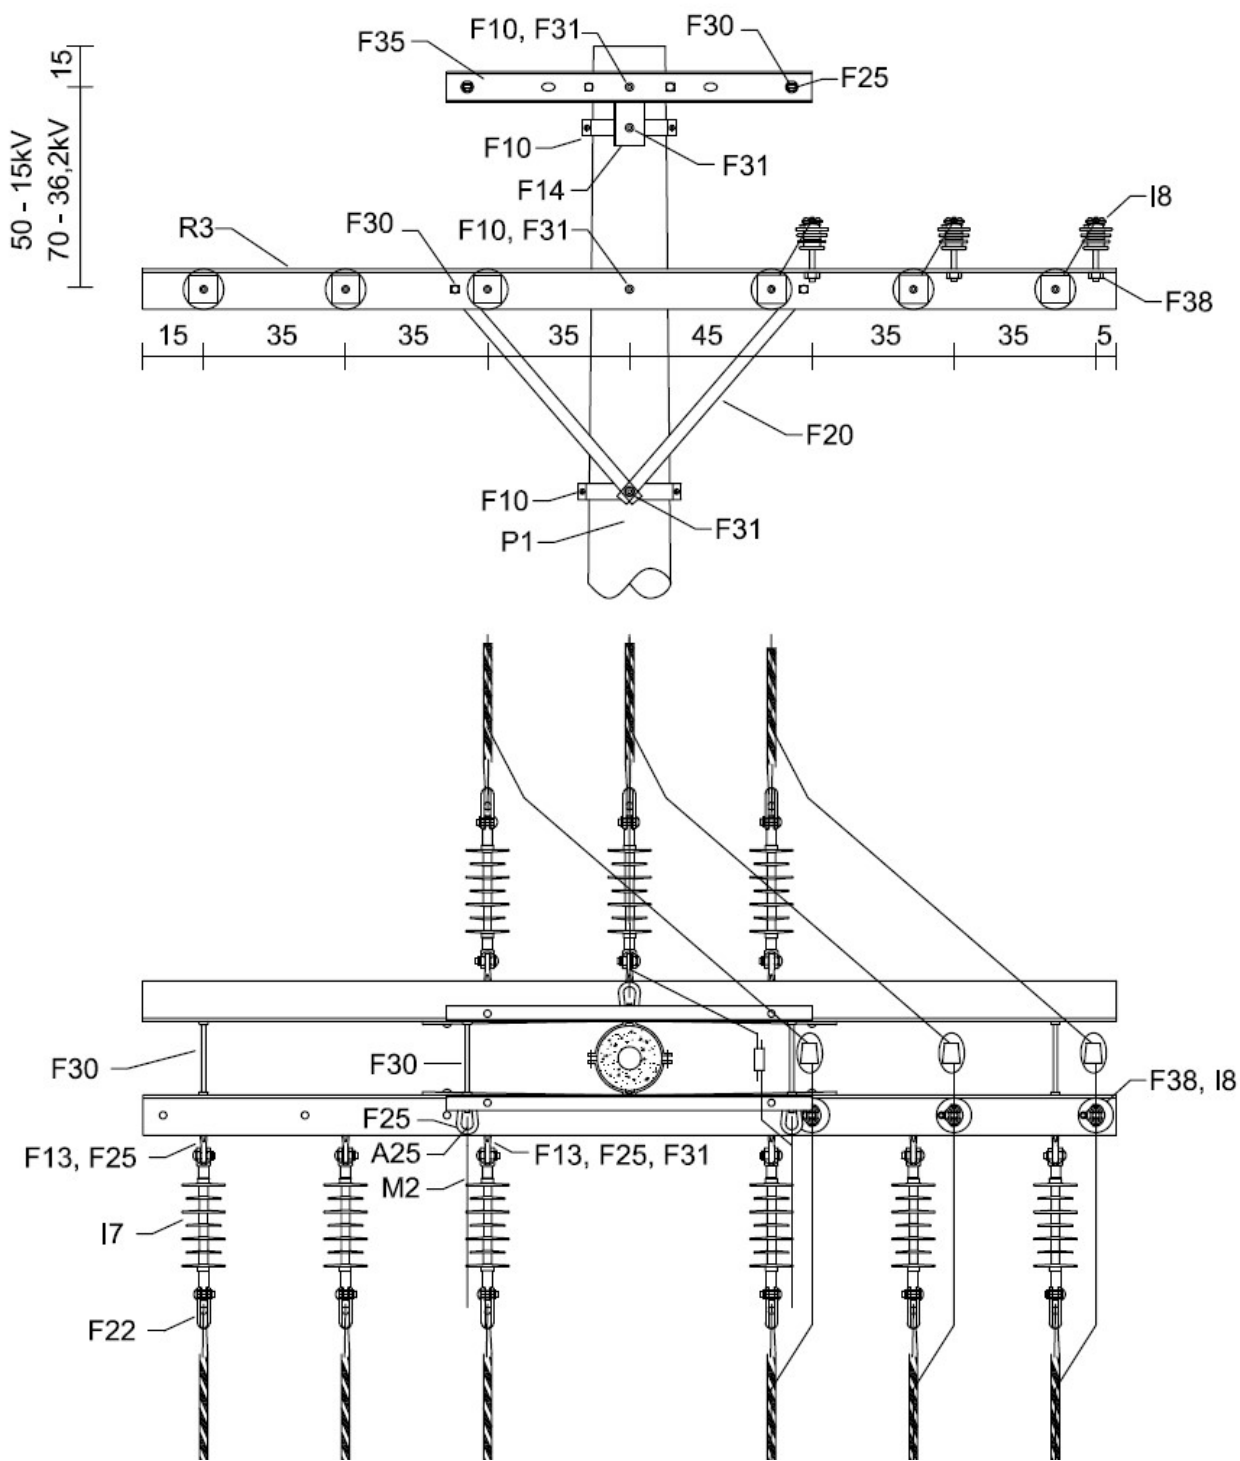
Estrutura CE33 – Poste de Concreto de Seção DT
